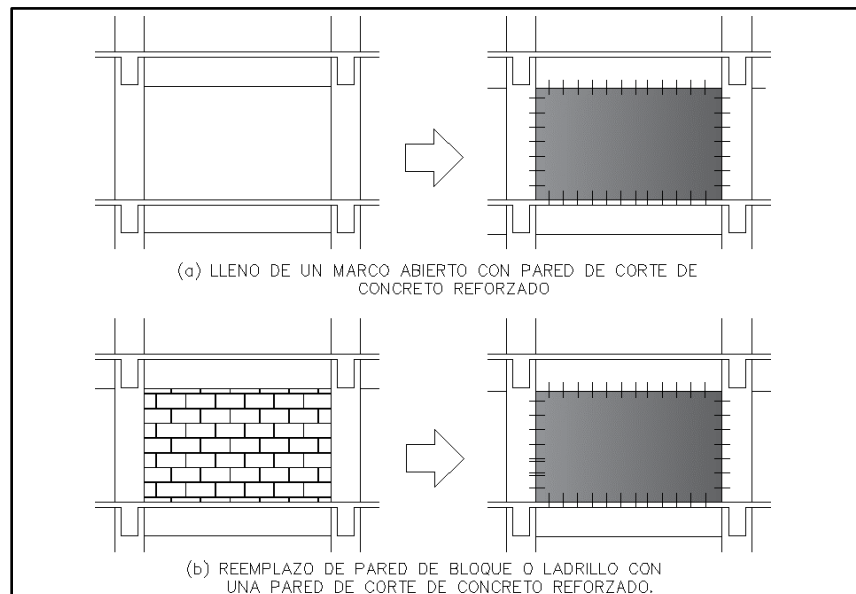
Reforzamiento mediante la instalación de una pared de corte
